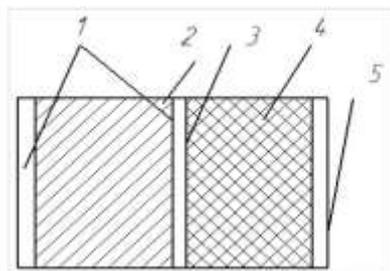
Конструкция наружной стены холодильника: 1- штукатурка цементная, 2 – кладка кирпичная, 3– пароизоляция, 4– теплоизоляция, 5– отделочный слой
